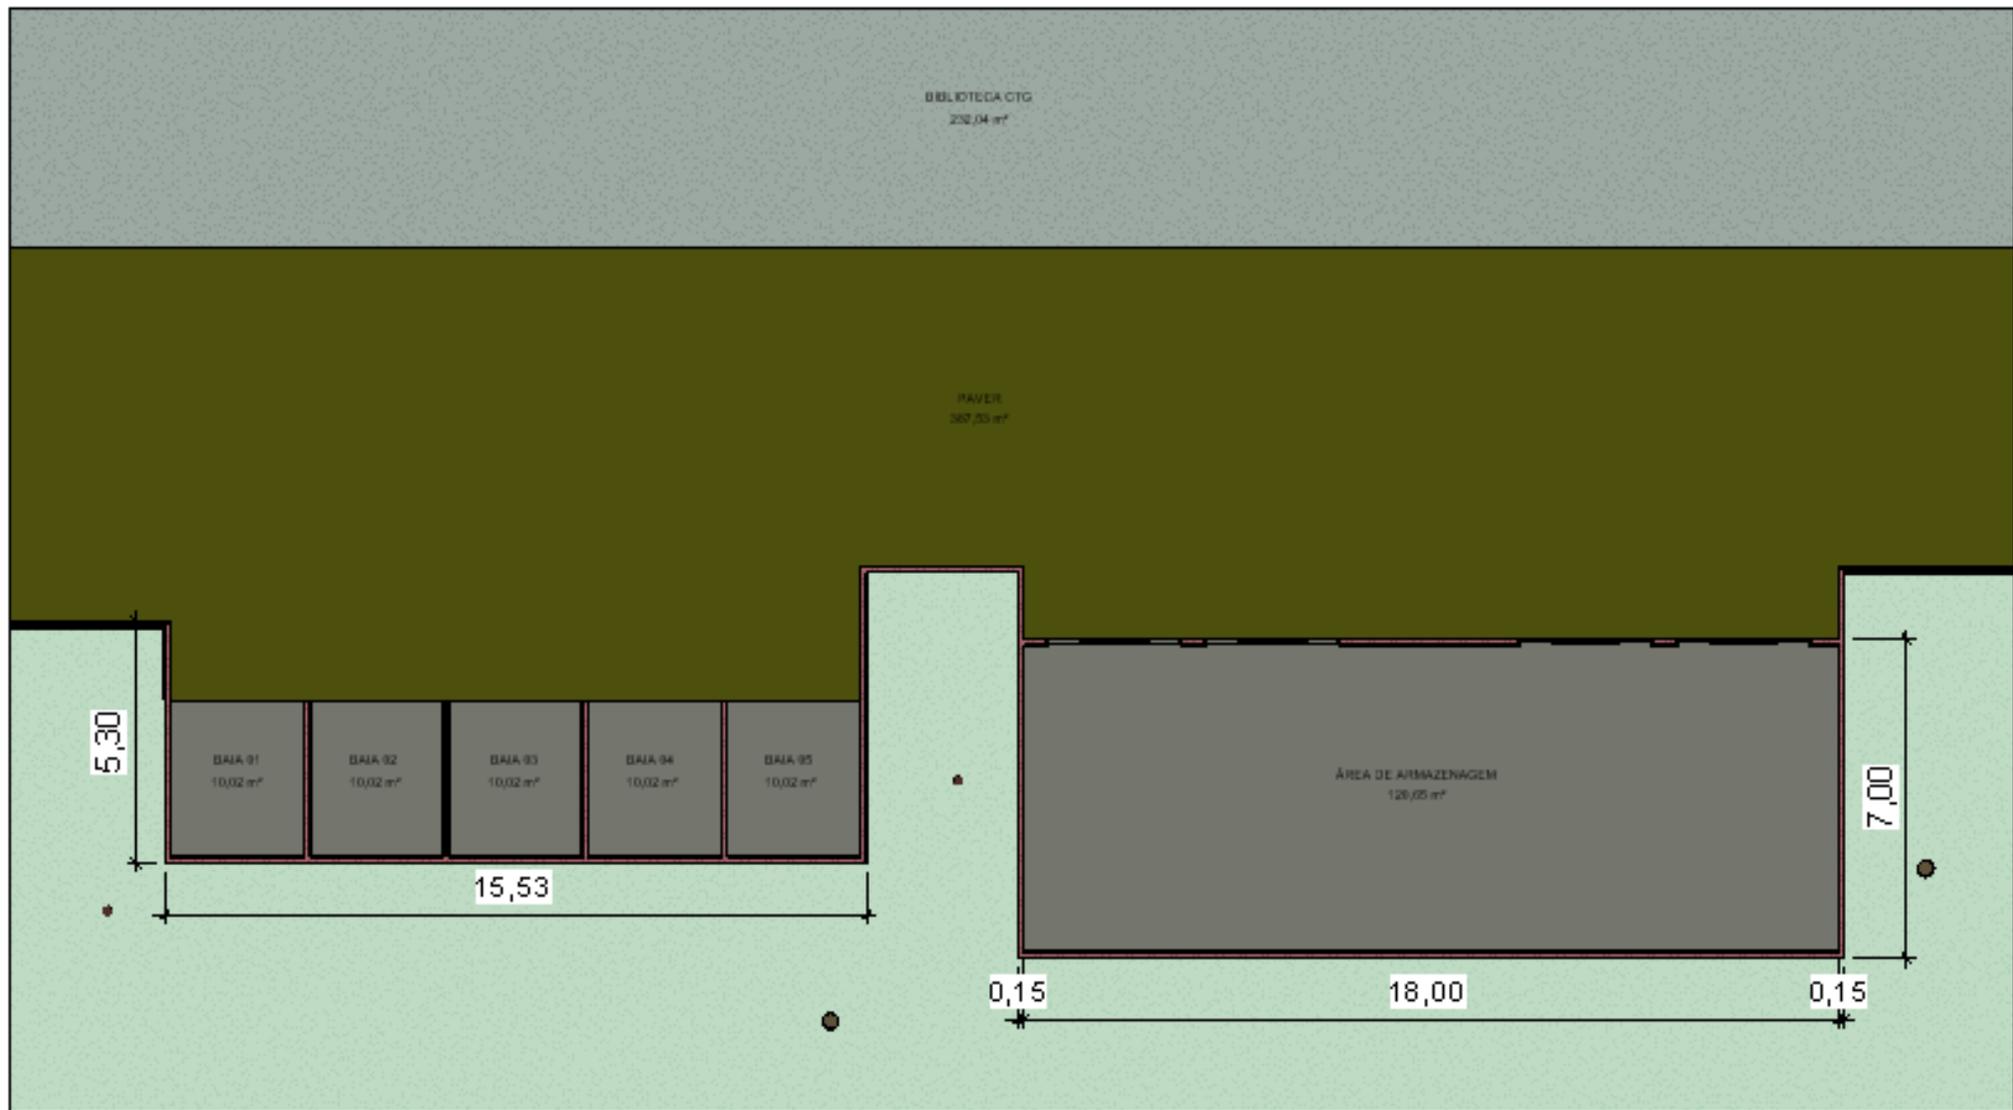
Planta Baixa do Novo Prédio – Depósito de Armazenagem
